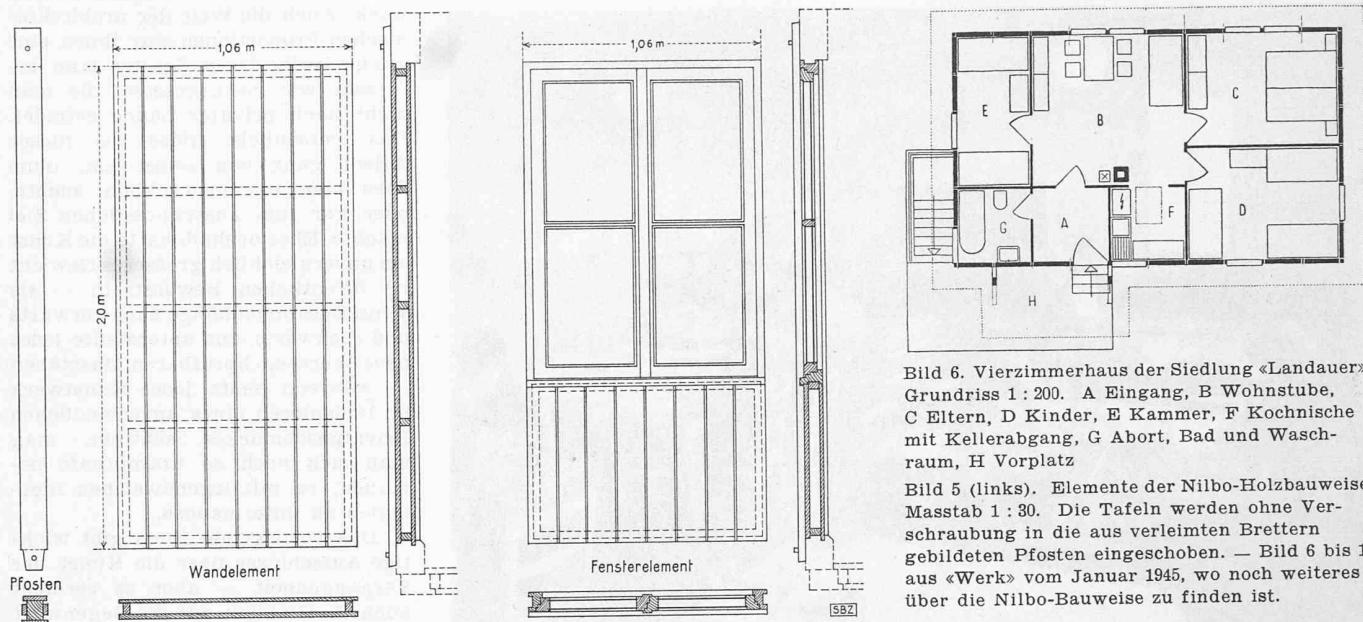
Vierzimmerhaus der Siedlung «Landauer», Grundriss 1 : 200. A Eingang, B Wohnstube, C Eltern, D Kinder, E Kammer, F Kochnische mit Kellerabgang, G Abort, Bad und Waschraum, H Vorplatz
